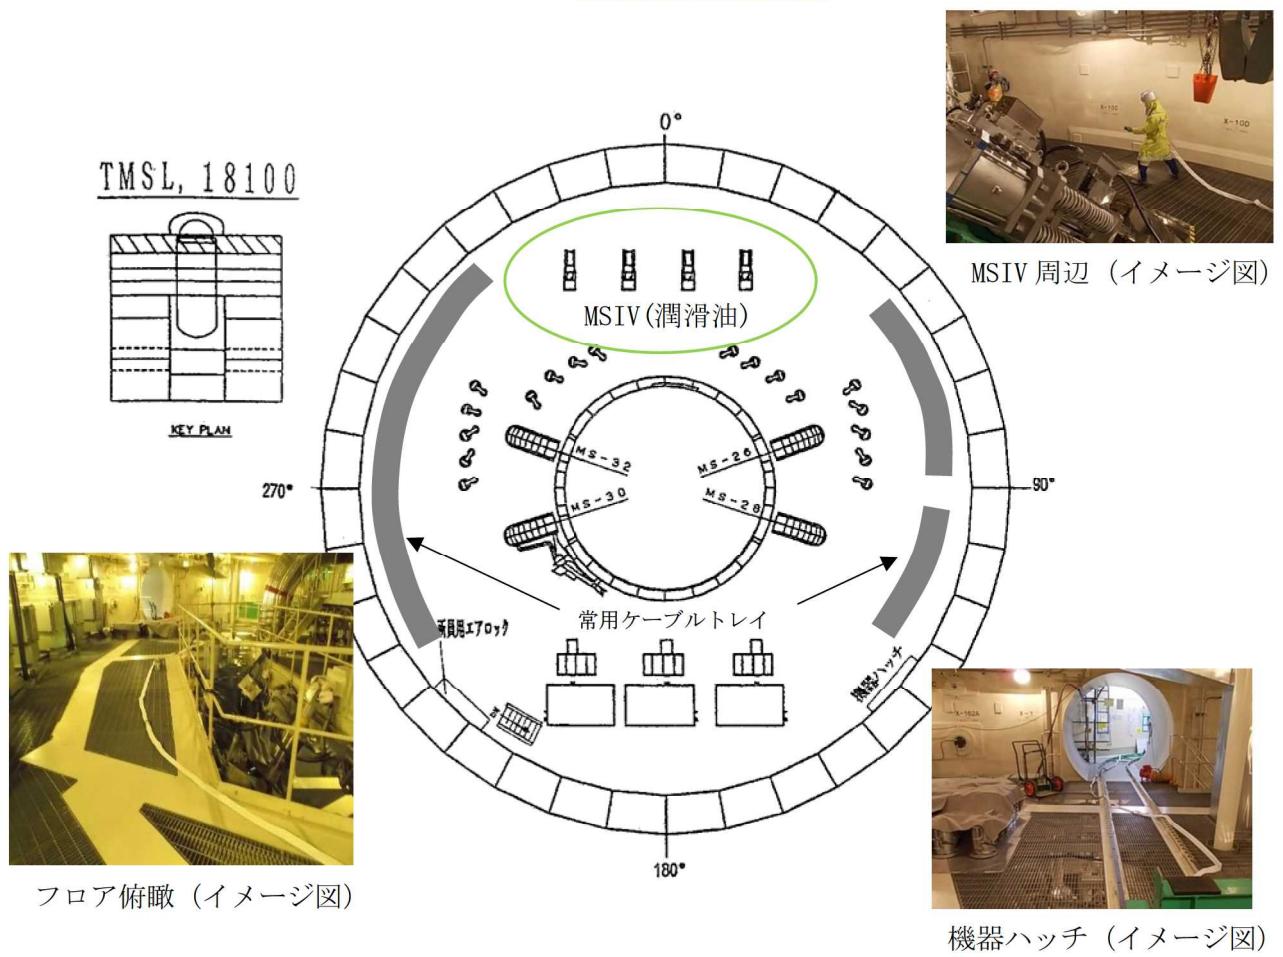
原子炉格納容器 ハッチ設置フロア 平面図
